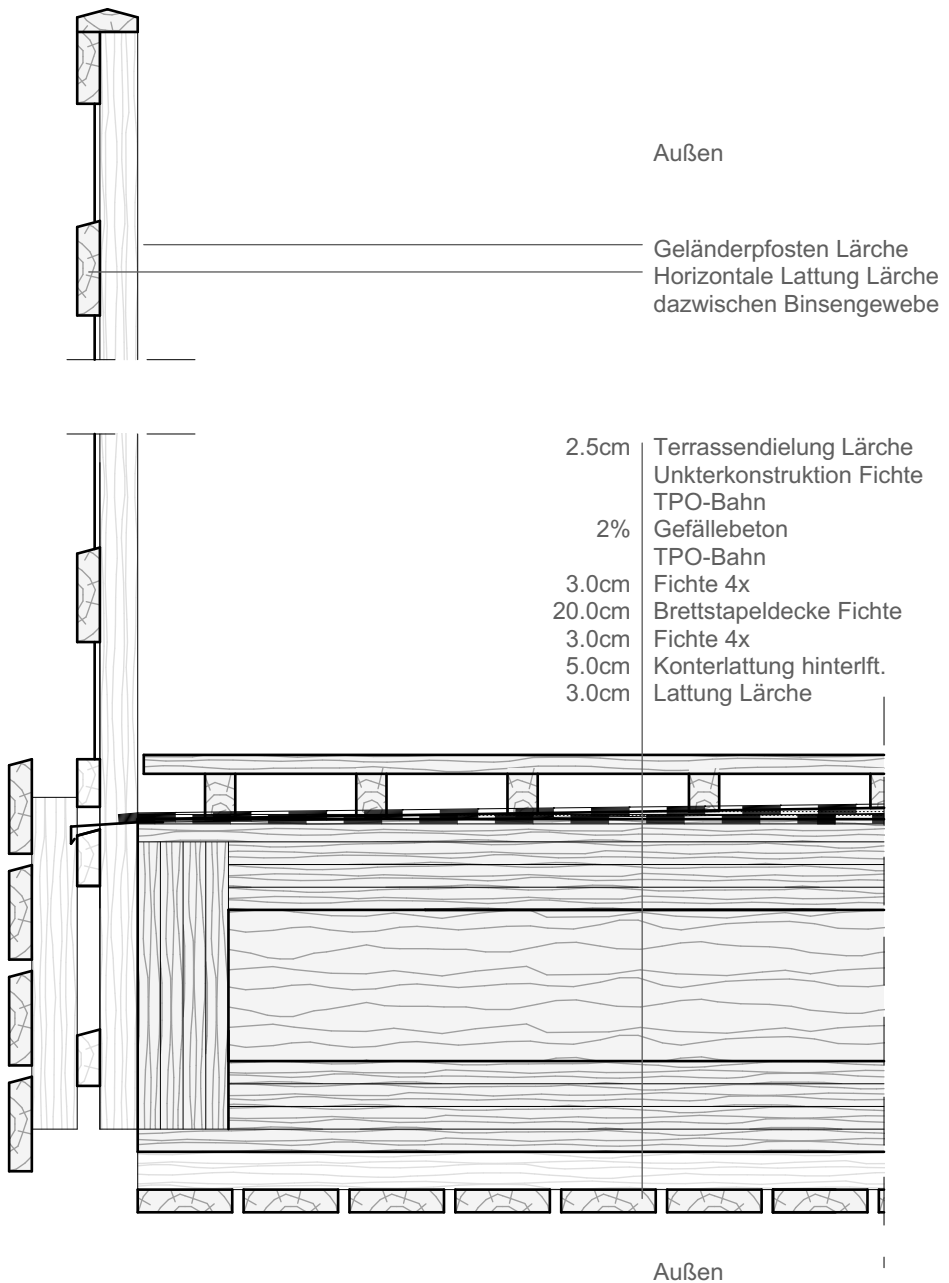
Balkon - Detail 4 M 1:10
